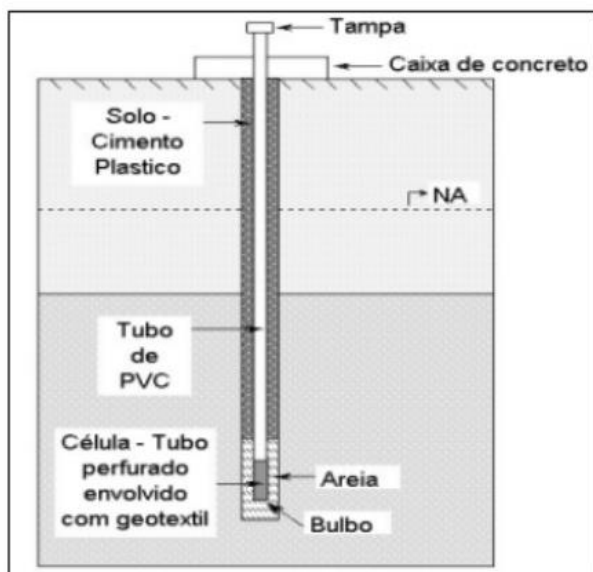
Instrumento Piezômetro utilizado no monitoramento por instrumentação, nas barragens do PISF- Eixo Leste.
